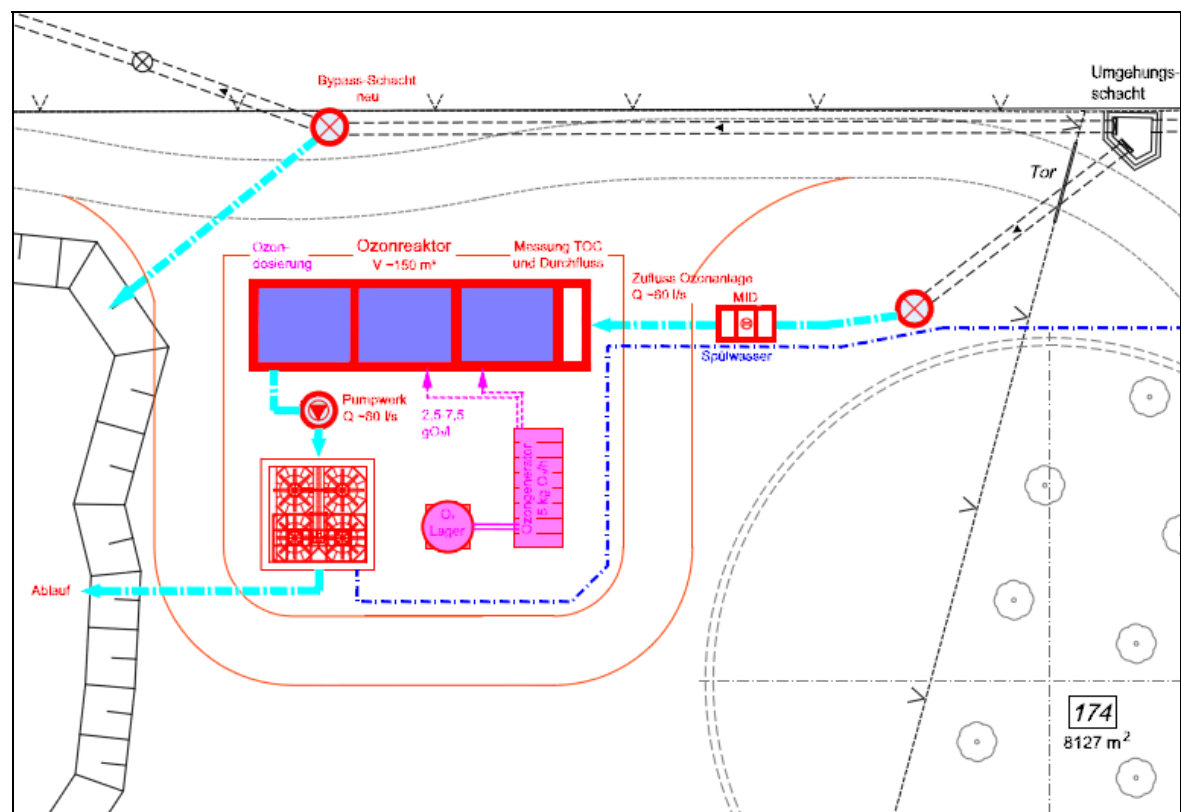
Lageplan KA Verl West - Variante 3.2 – Ozonung, Dyna-Sand Filtration
